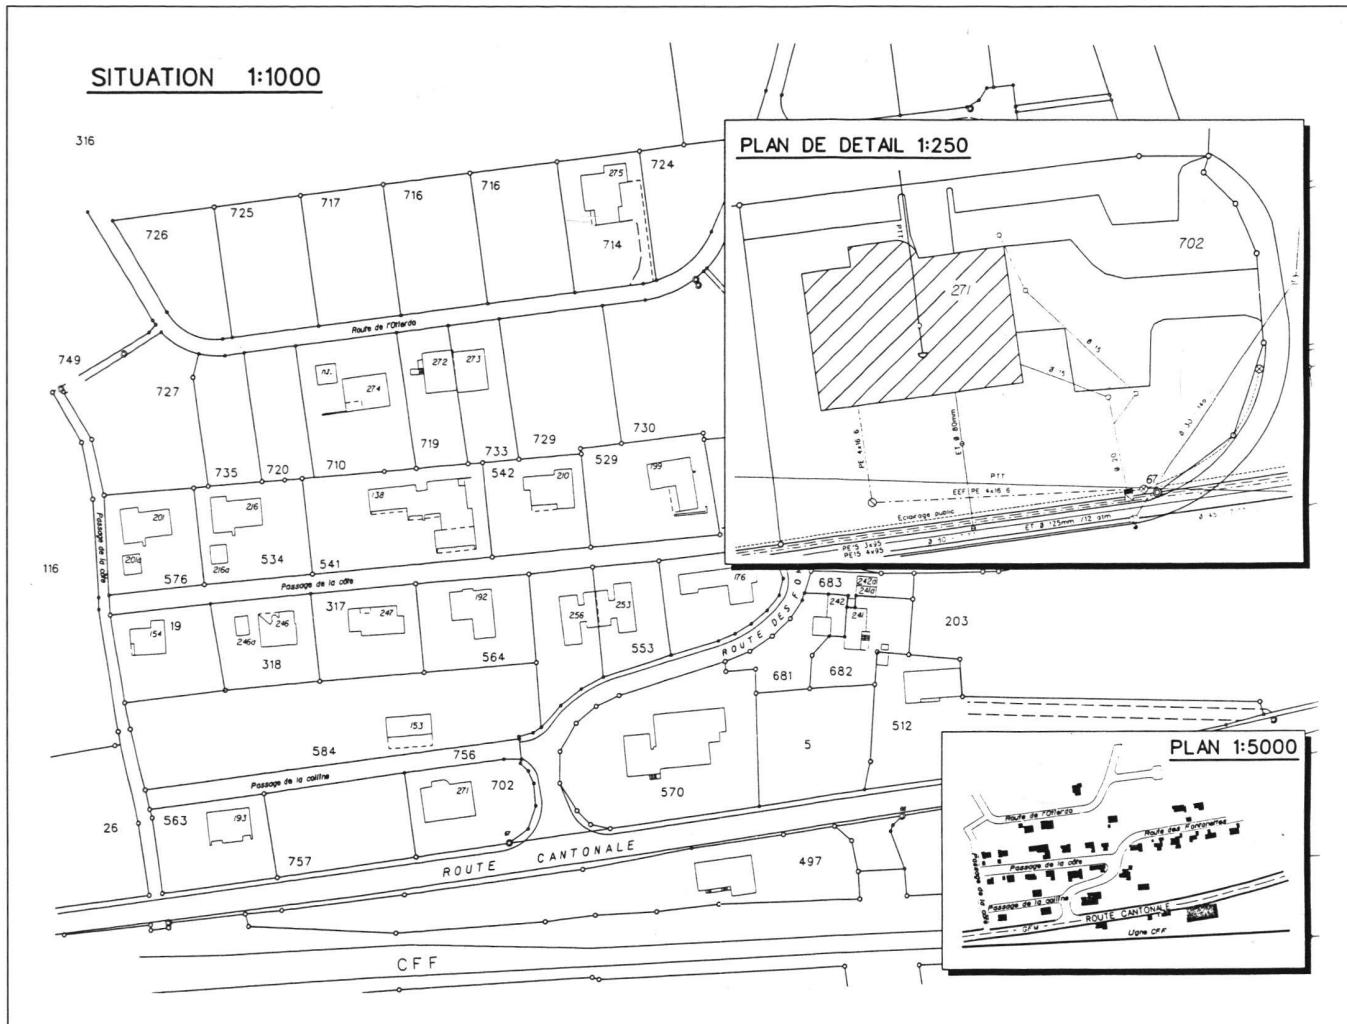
Situation 1:1000, Plan de détail 1:250, Plan 1:5000 (réduits).
